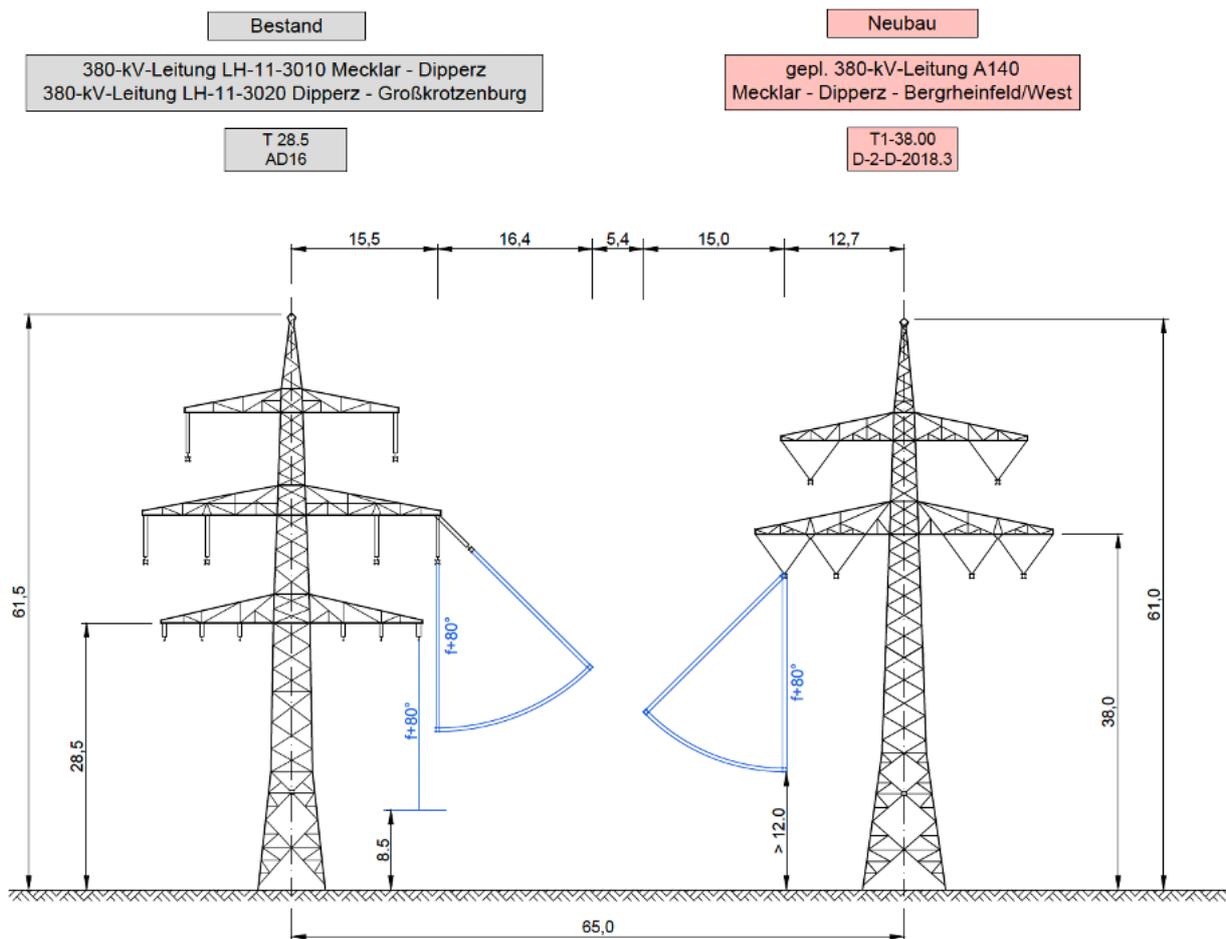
Parallelführung einer 380-kV-Neubautrasse neben der 380-kV-Bestandstrasse (alle Maße in m)
